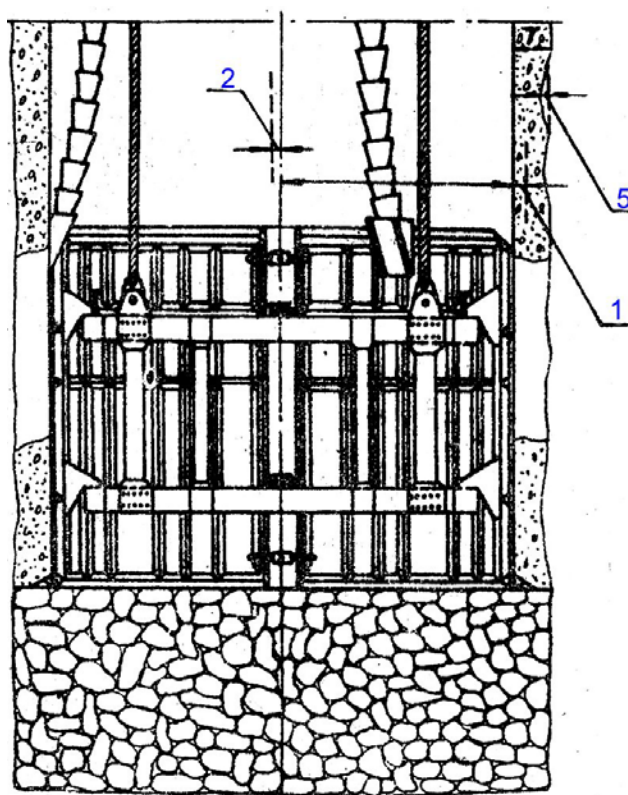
Допустимые отклонения при возведении бетонной (железобетонной) крепи ствола
